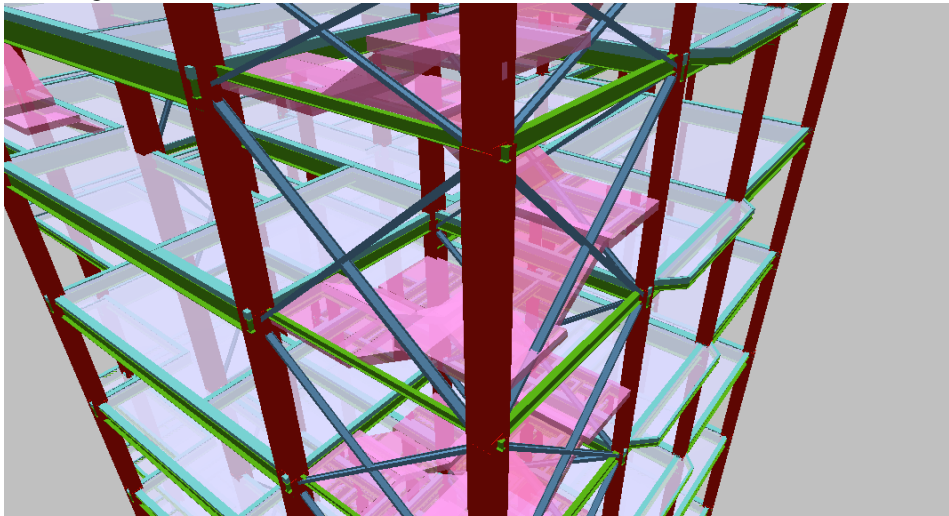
Detalha de apoio da laje steel-deck sobre a viga de aço.
